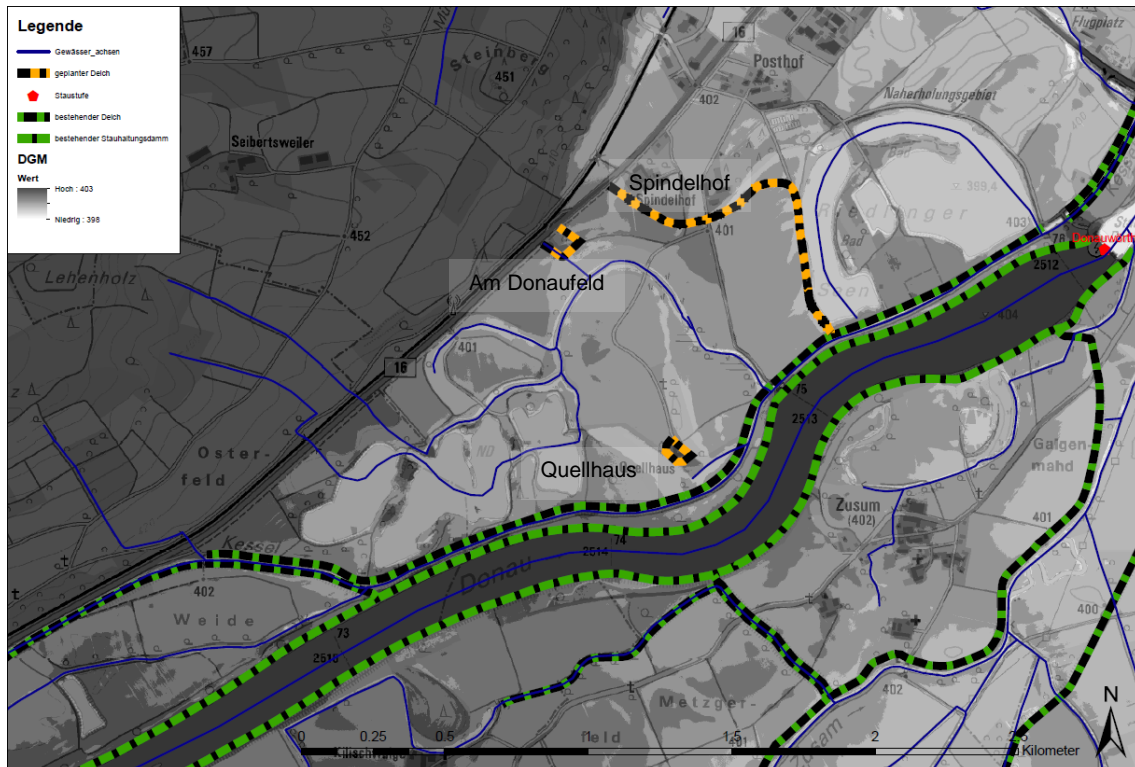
Lageplan Rückhalteraum Donauwörth, ROVar B
